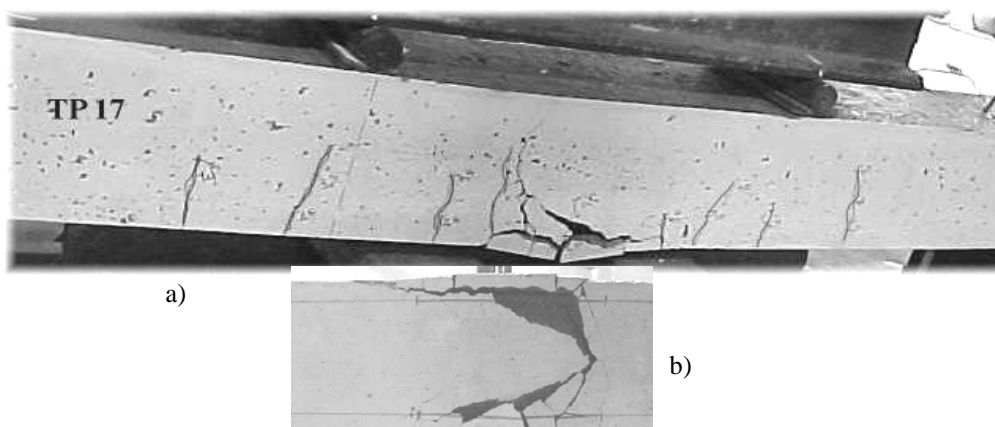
Viga *TP17* – a) vista lateral - b) vista da ruptura de fundo.
